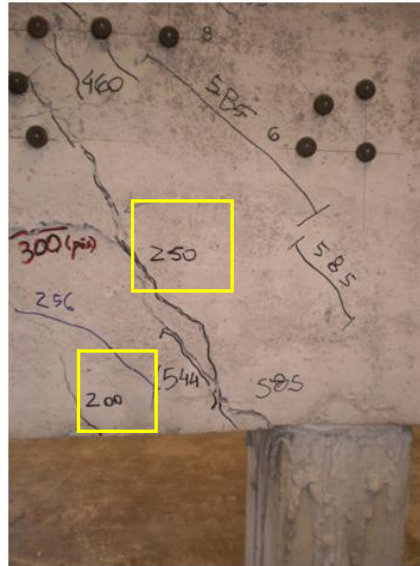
Primeiras fissuras anotadas no modelo B110P125R4
